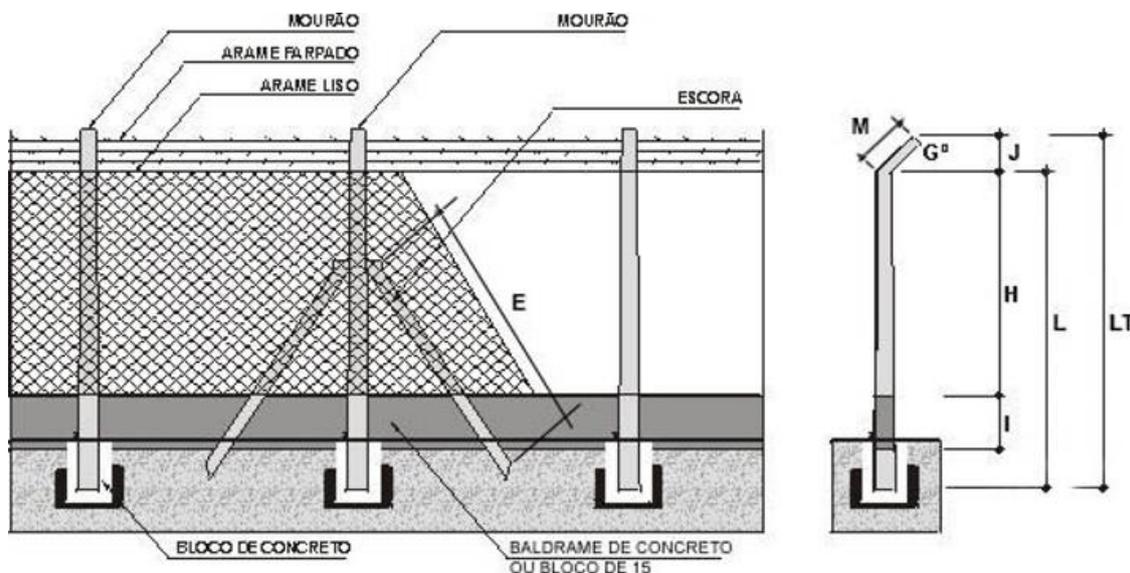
Cerca típica utilizando mourões de concreto e tela de arame losangular
